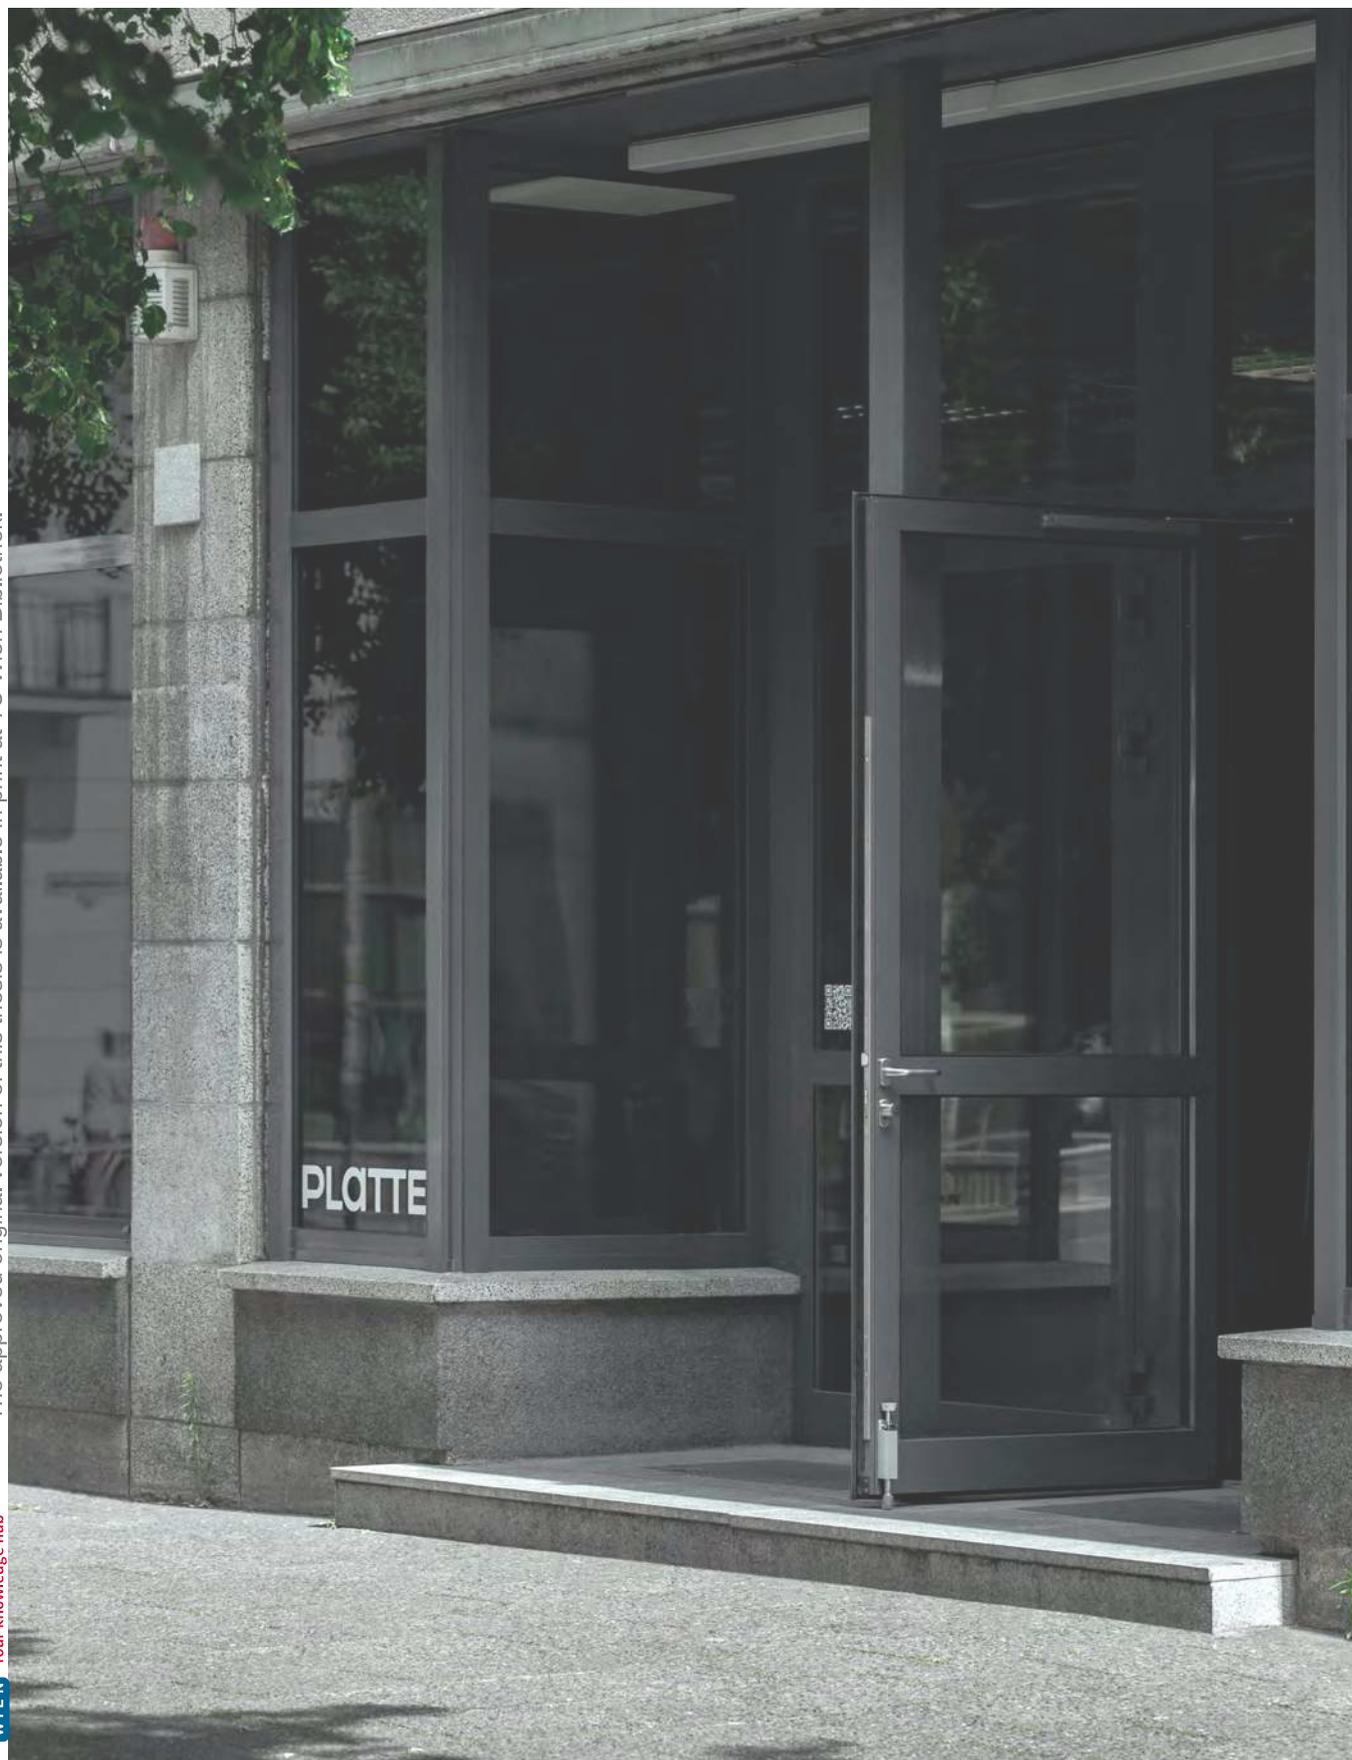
Bekleidungsgeschäft Platte. Eingangsbereich Erdgeschoss, Bauteil A
